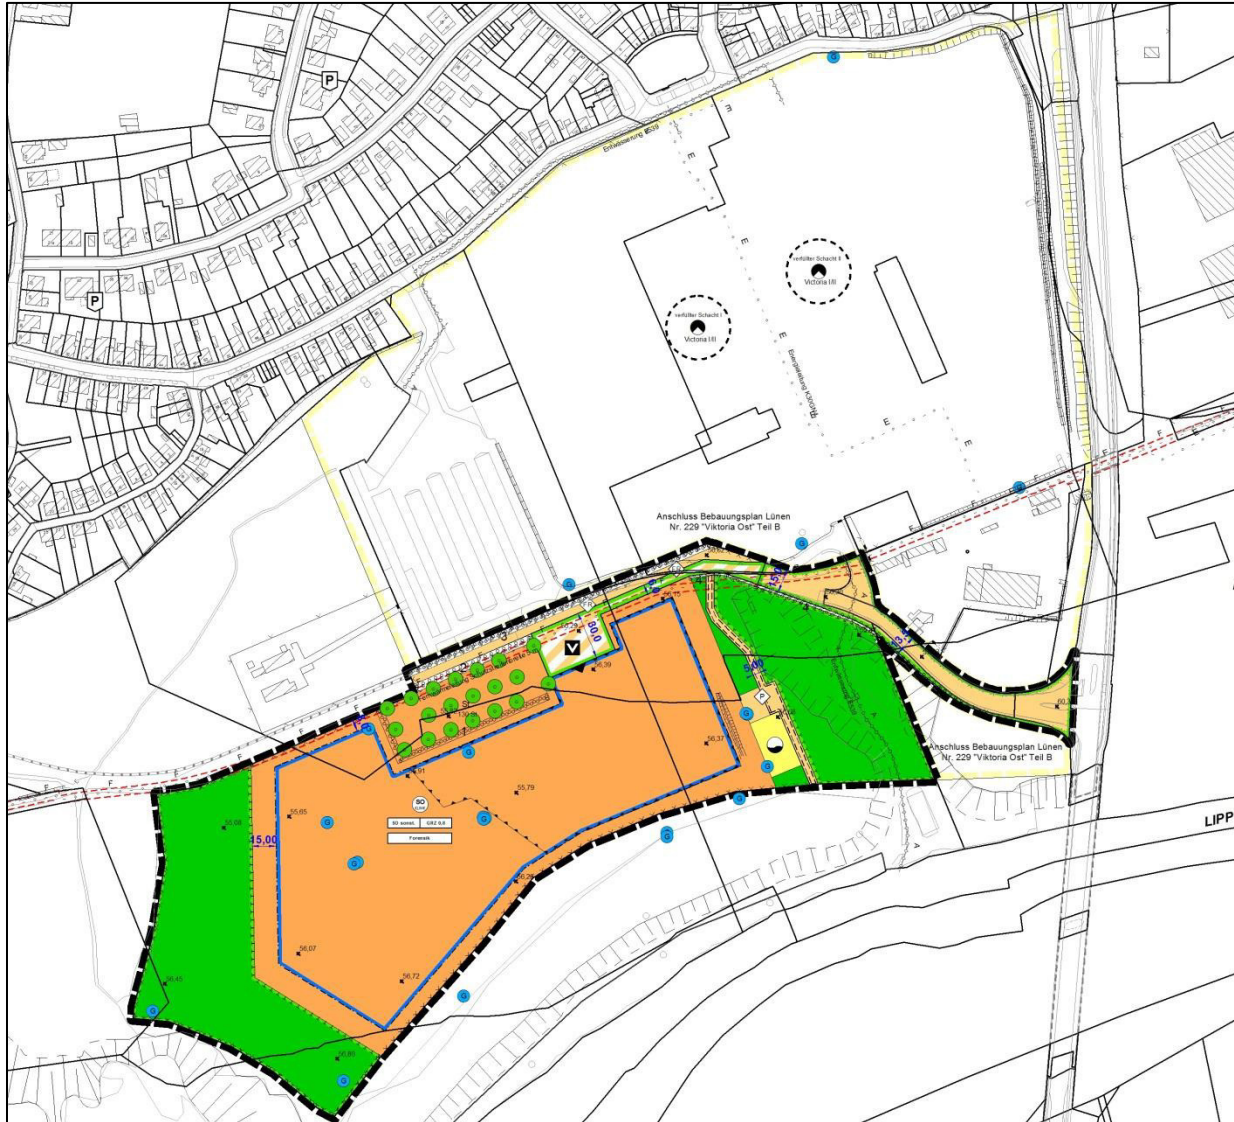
Übersicht Teilbereiche Bebauungsplan Nr. 229, Entwurf Teil A
